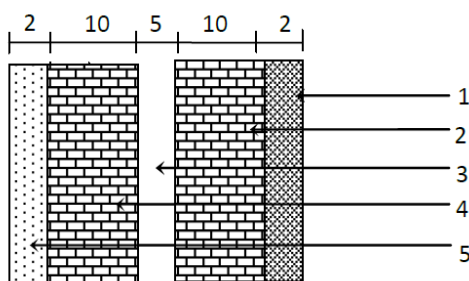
Coupe verticale d'un mur extérieur.
